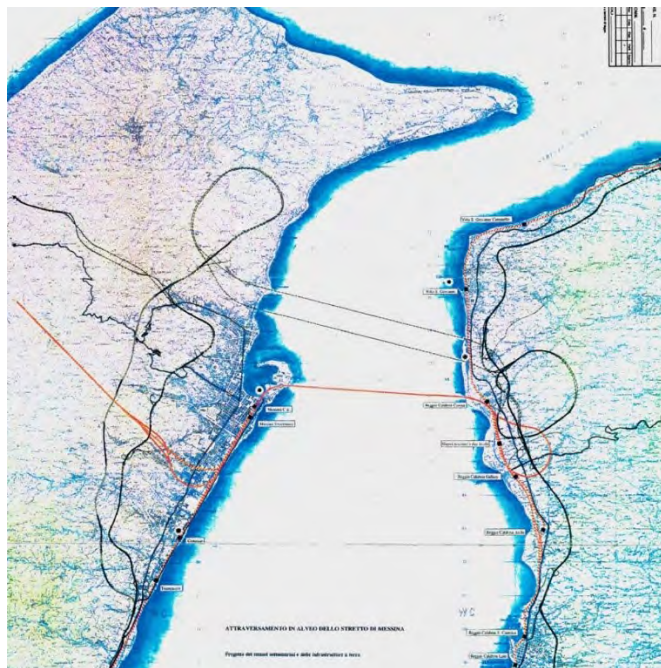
Tunnel sommerso progetto ENI 1993 – Planimetria (in rosso il tunnel ferroviario, in nero i tunnel stradali)
